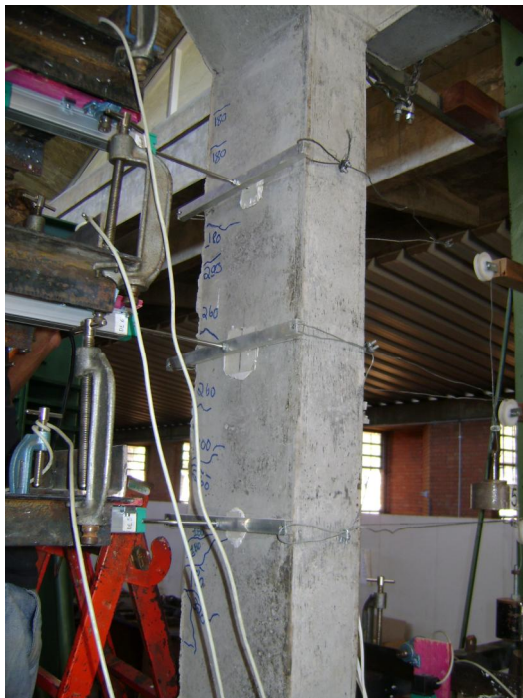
Fissuras do pilar PFN 15-2
